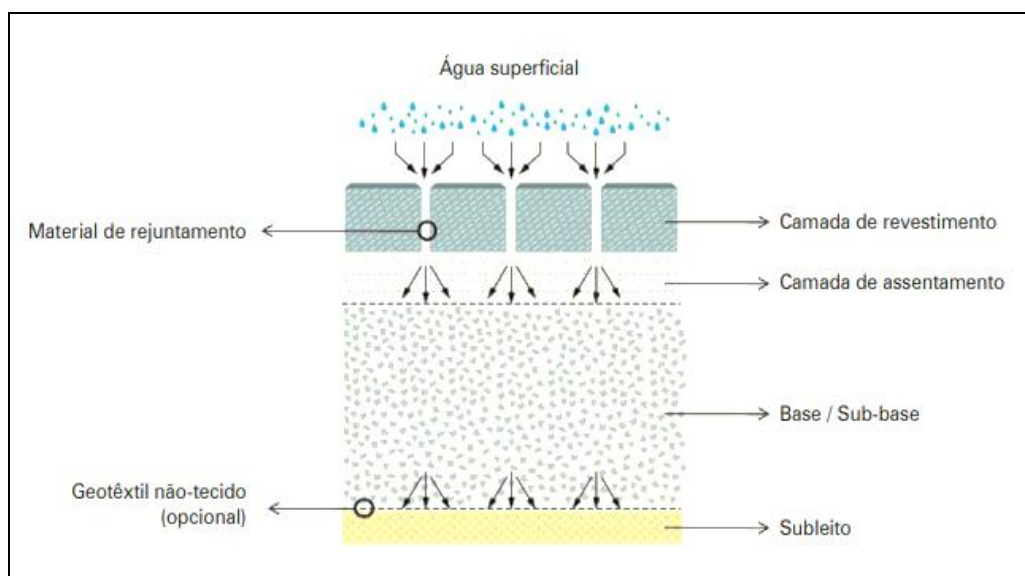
Exemplo do uso da manta geotêxtil na pavimentação de vias
